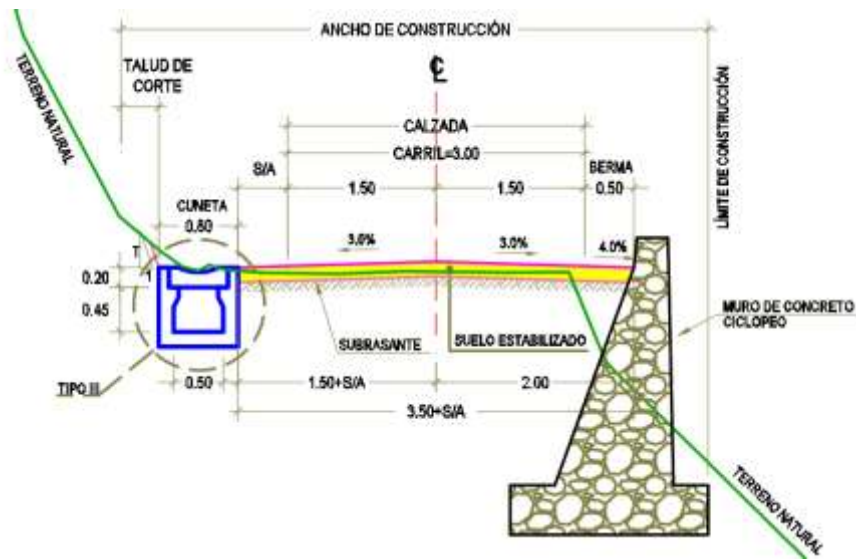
Sección típica con cuneta rectangular y muro de contención. Fuente: Plano de secciones Típicas.
